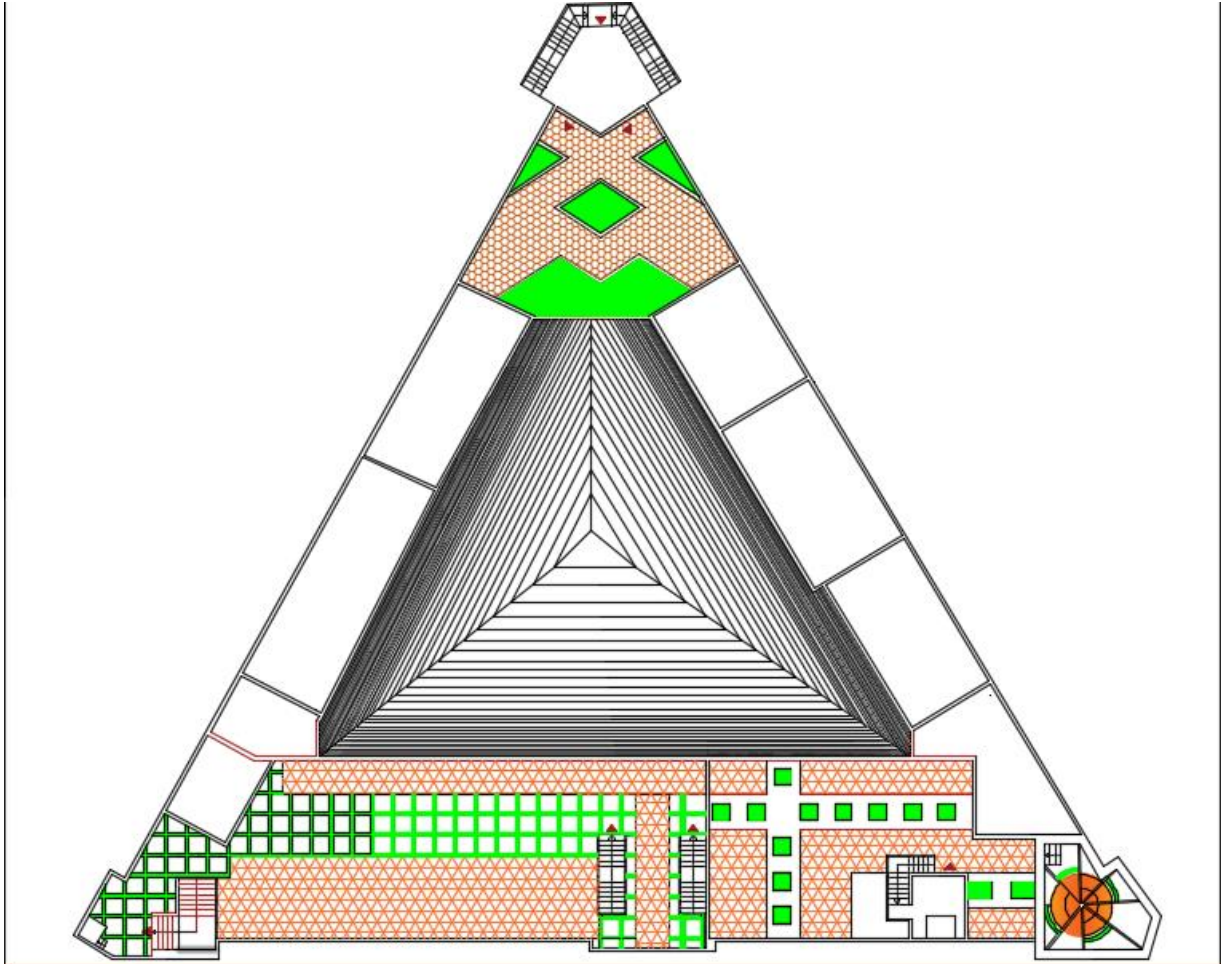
Plan des terrasses et de toit centrale- élaboré par l'auteur
